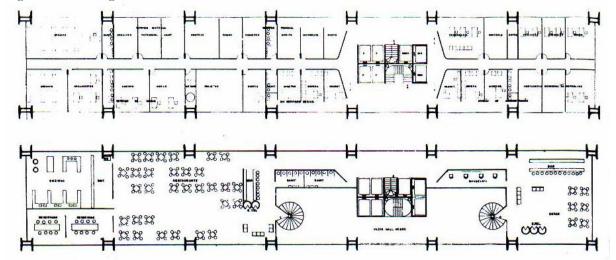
planta tipo com lay-out para os ambientes de trabalho; planta mezanino mobiliado.
